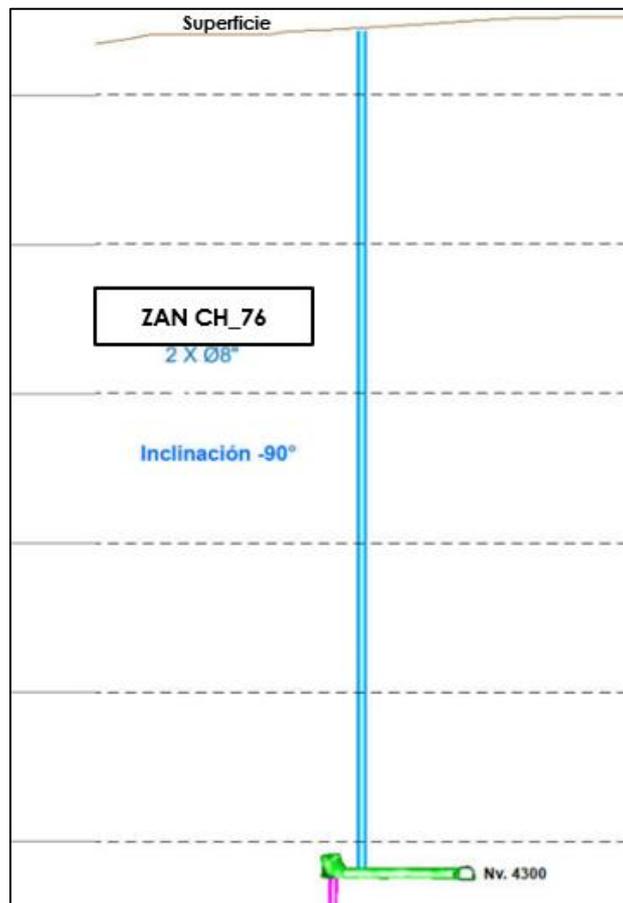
Vista en perfil Poste A6 - Poste A7 (chimenea ZAN CH\_76)
